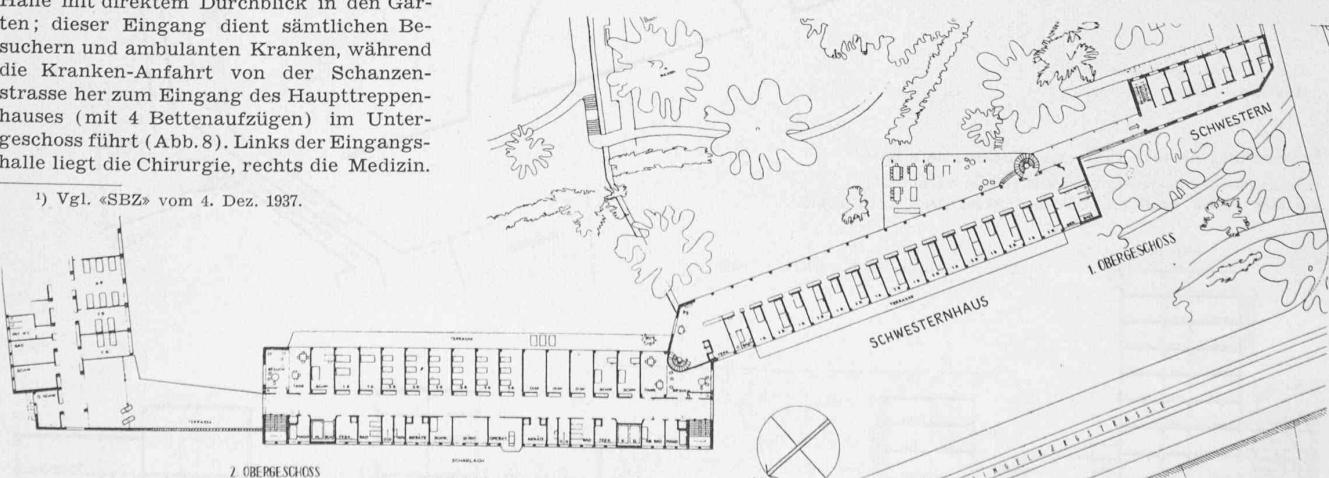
Grundrisse vom Infektionshaus und Schwesternhaus lt. Erweiterungsprojekt 1937. — 1 : 1000.
